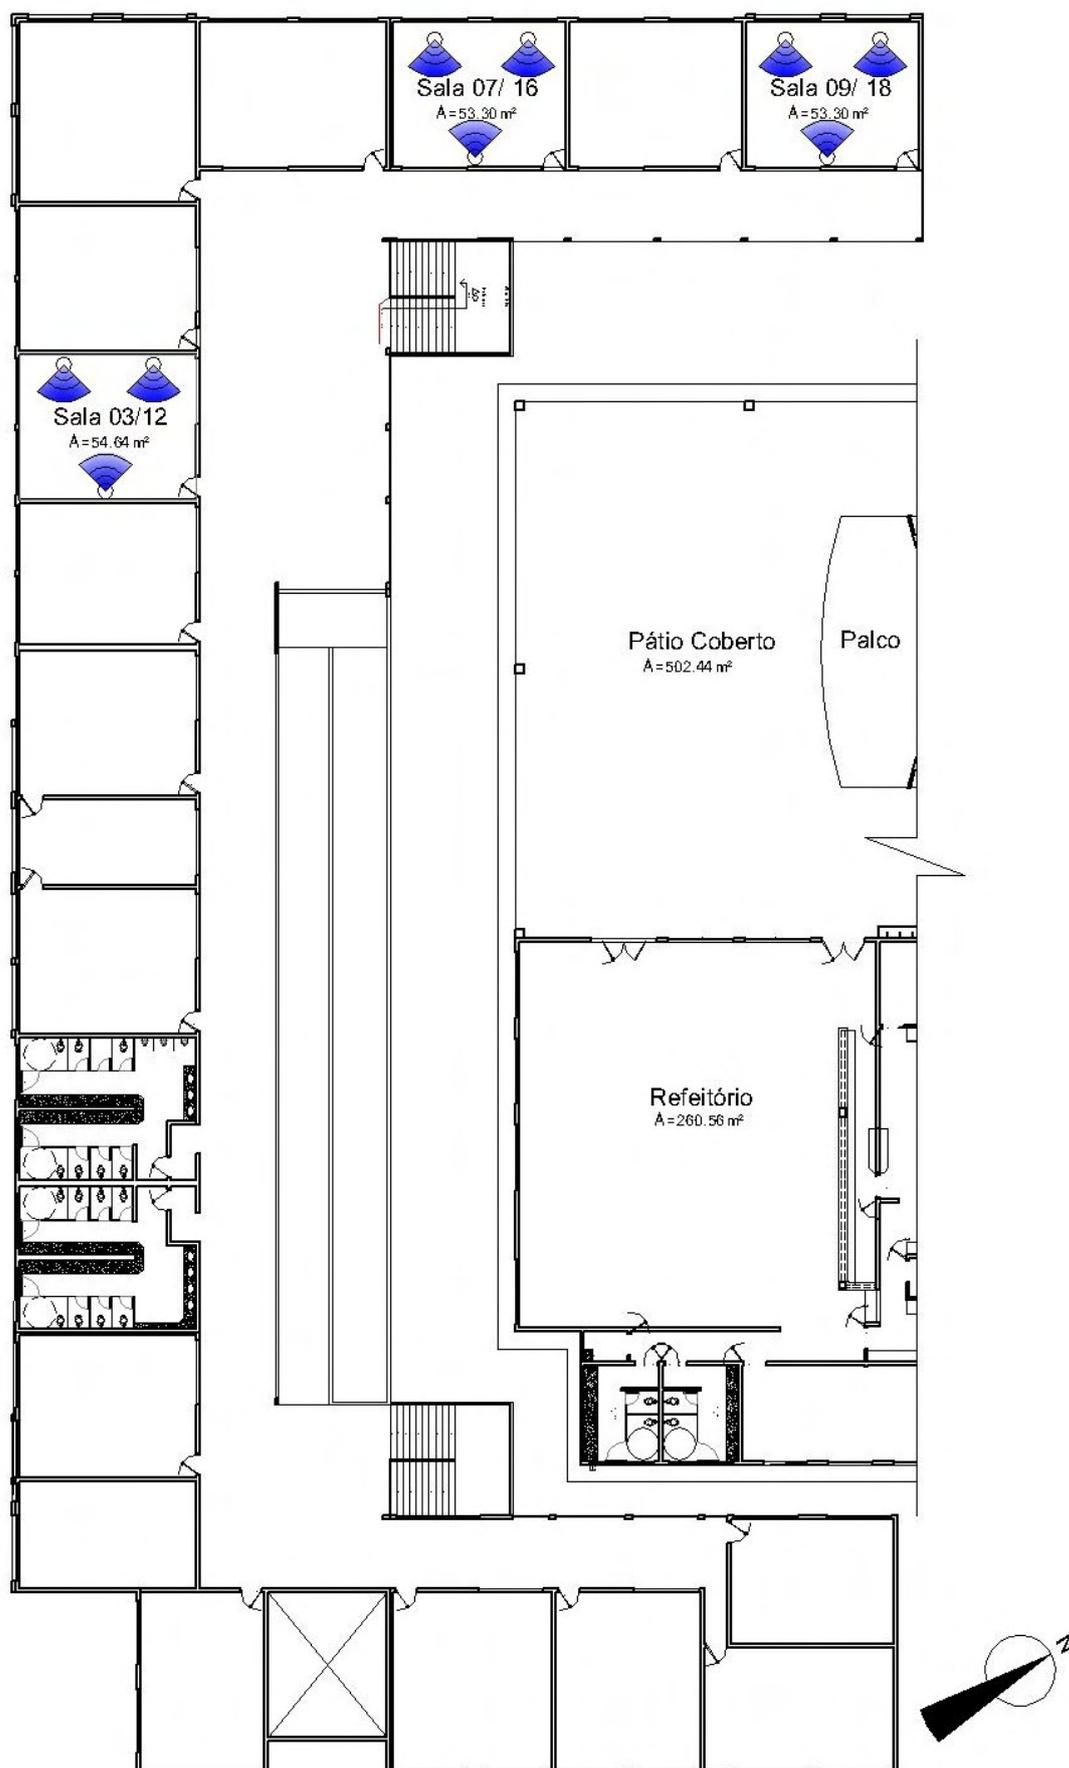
Planta Baixa Térreo - Pontos medição acústica
